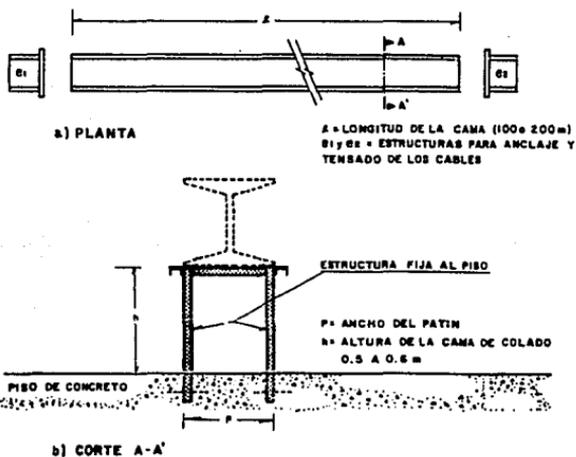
CAMA PARA TENSADO Y COLADO DE PILOTES PREESFORZADOS
